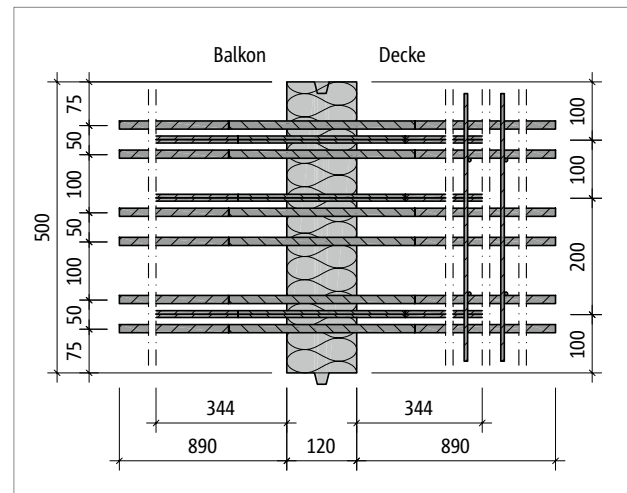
Schöck Isokorb® XT Typ DP-MM6-VV1: Grundriss
